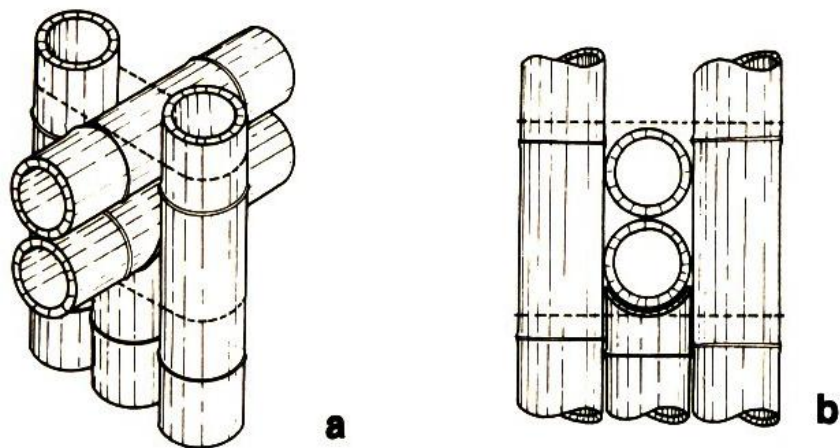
Viga dupla central. Muito usada em estruturas de pontes e instalações rurais.
